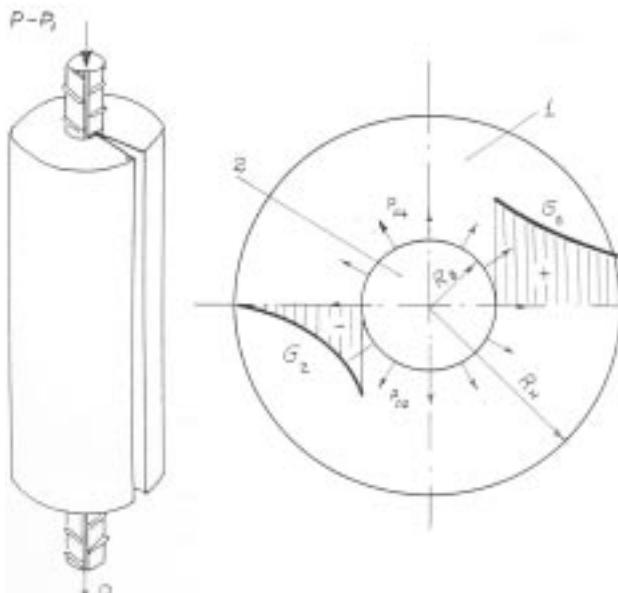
Расчетная схема для определения давления арматуры на бетон: 1 – бетонный образец, 2 – арматура
